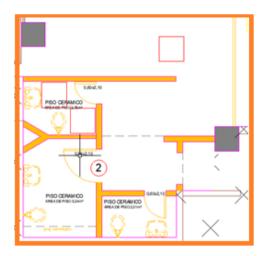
Rebaixo no teto localizado nos banheiro de uso privativo
